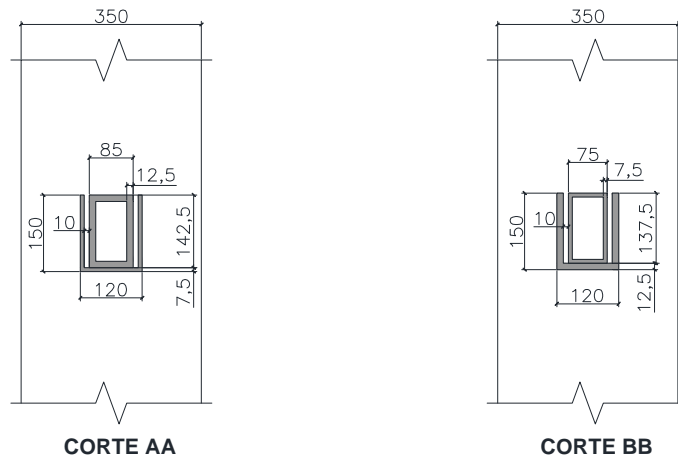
Geometria dos pilares e viga utilizados no ensaio.
